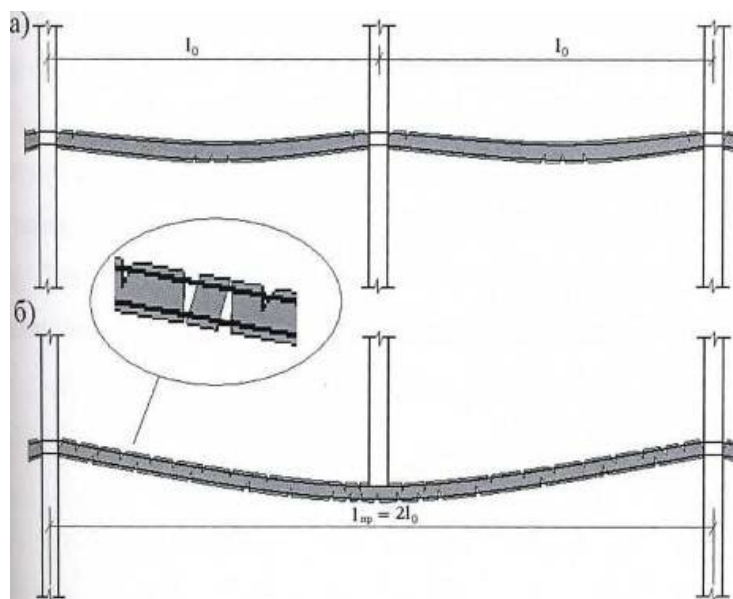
Деформации железобетонных перекрытий в стадии работы их арматуры и вантовой системы: а) до разрушения колонны; б) после выхода из строя колонны
